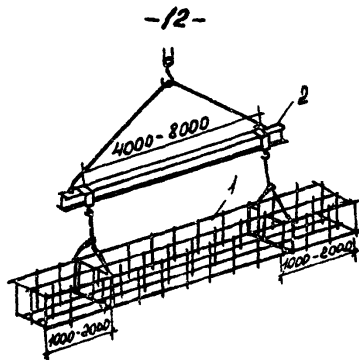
Схема монтажа арматурного блока ленточного фундамента, фундаментного блока и др.: 1- армоблок; 2- траверса
